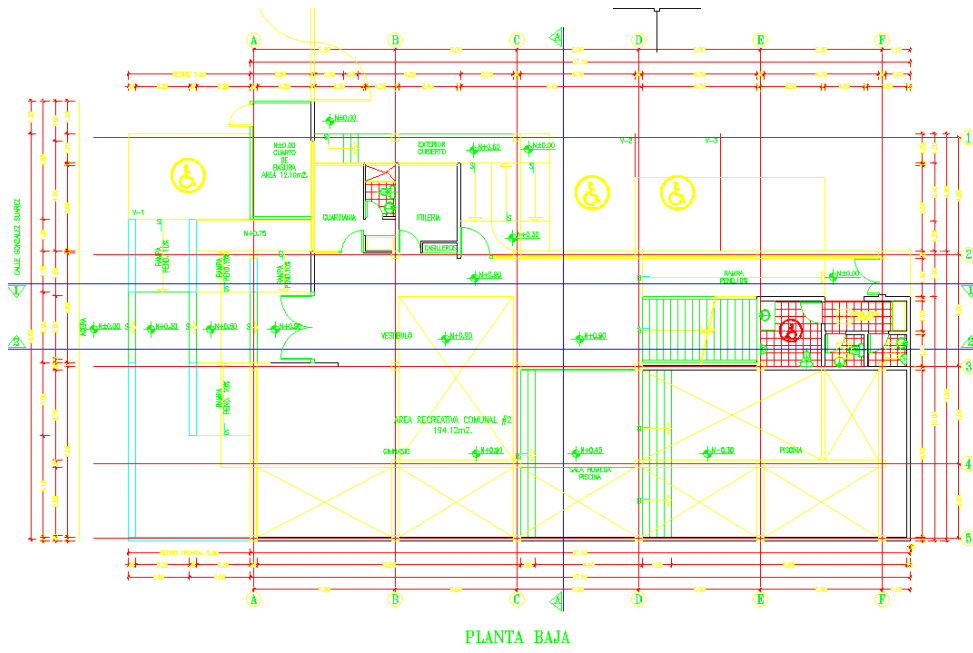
Planta baja Área Social “LUXOR PLAZA”
